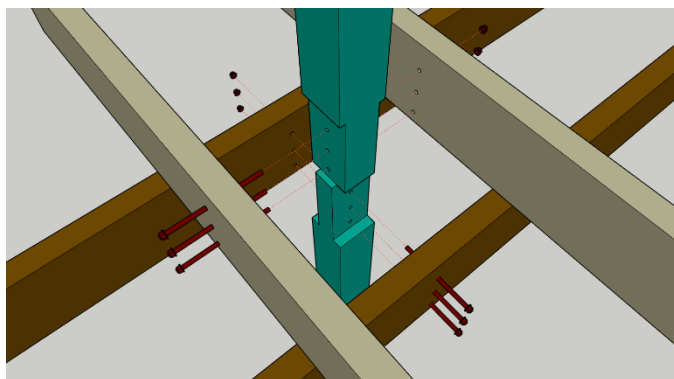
Узел опирания обвязочных балок и балок покрытия на колонну
